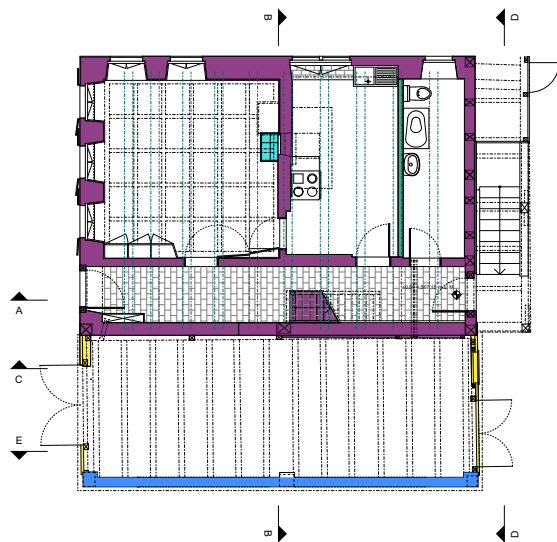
Grundriss EG Bauphasenpläne
